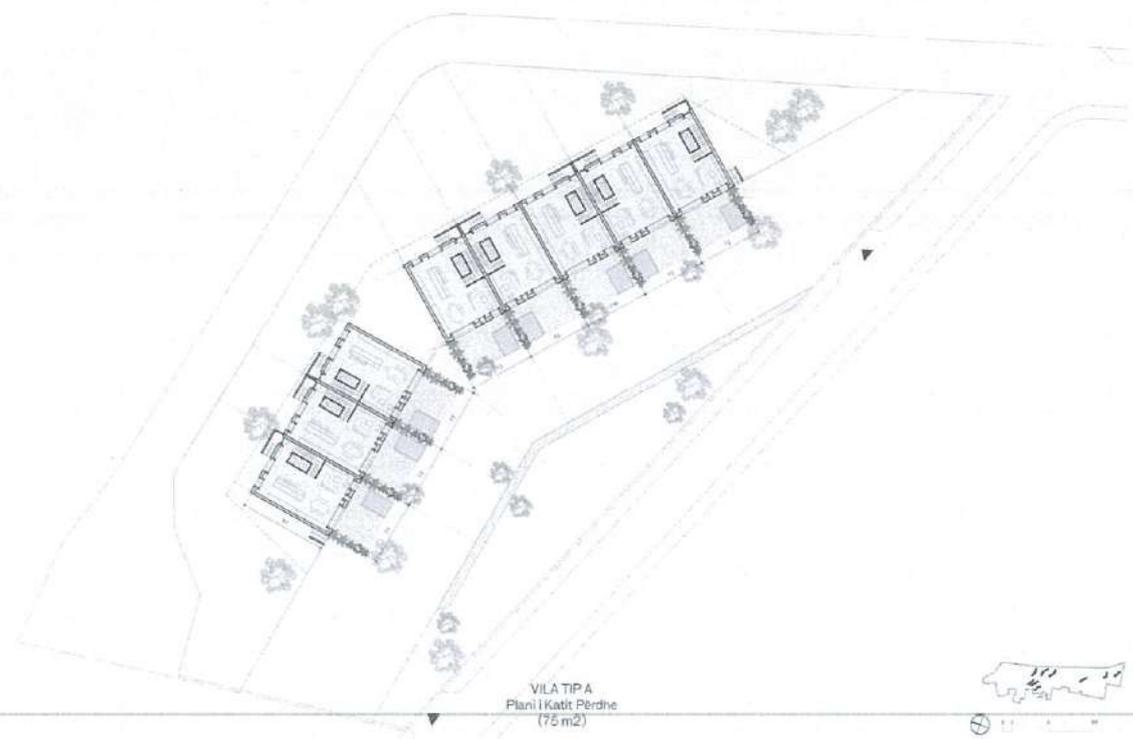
Plansistemi i një volumi me vila të tipit A
